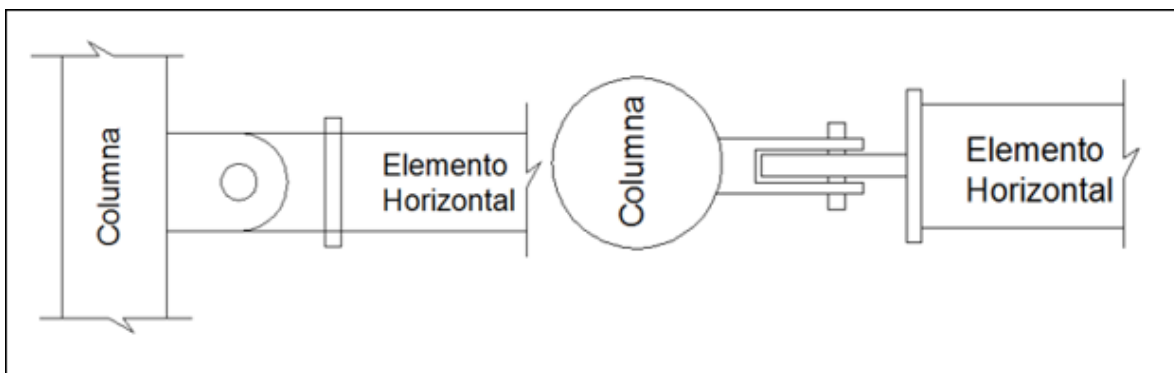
Conexión pernada tipo columna-elemento (vista frontal y aérea, respectivamente) Fuente propia.
